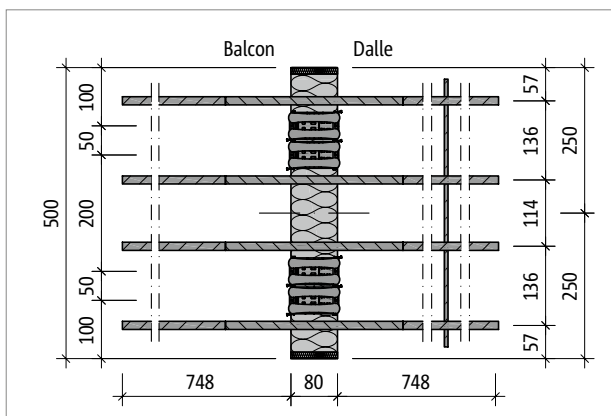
Schöck Isokorb® T type Q-E-V7-L500 : plan de base du produit
